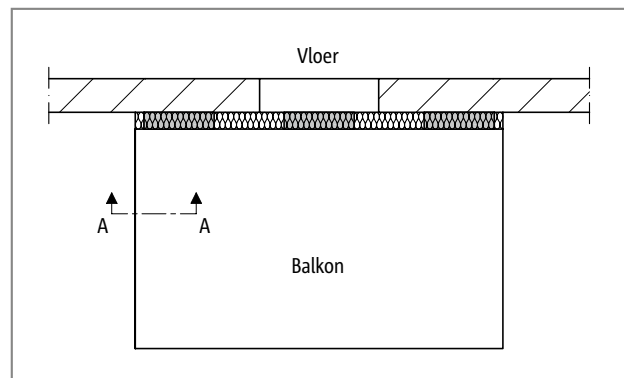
Schöck Isokorb® CXT type K-E: bijlegwapening; vloerplaatrand
